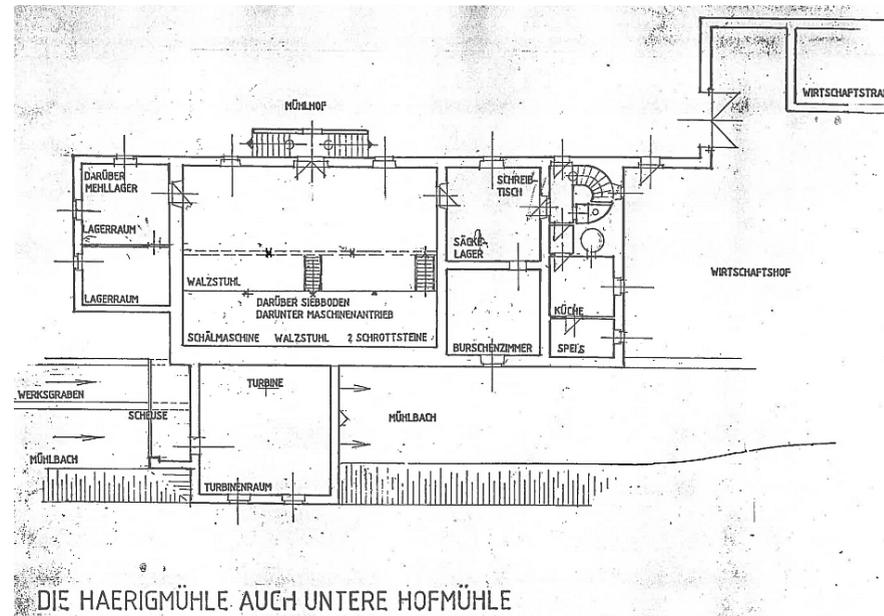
Plan aus 1985, die Häringmühle nach dem Umbau 1916, M 1:500
